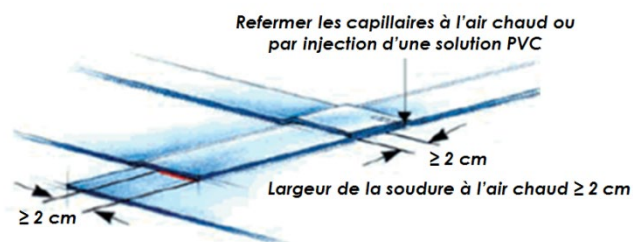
Mise en œuvre des joints en T (soudage à l'air chaud)
